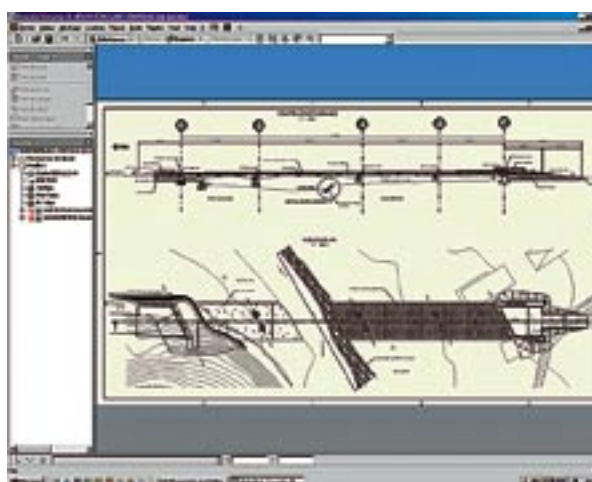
exemple de mise en plan 2D du pont de Fos sur la Garonne
